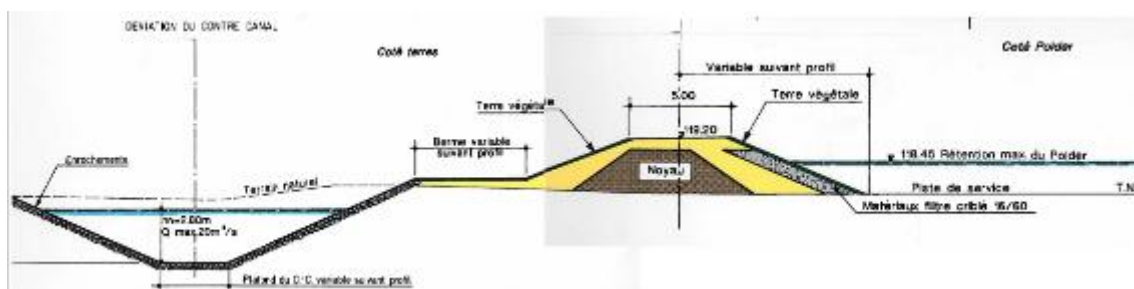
Coupe de la digue ceinture sur la face Ouest avant l'OH5
